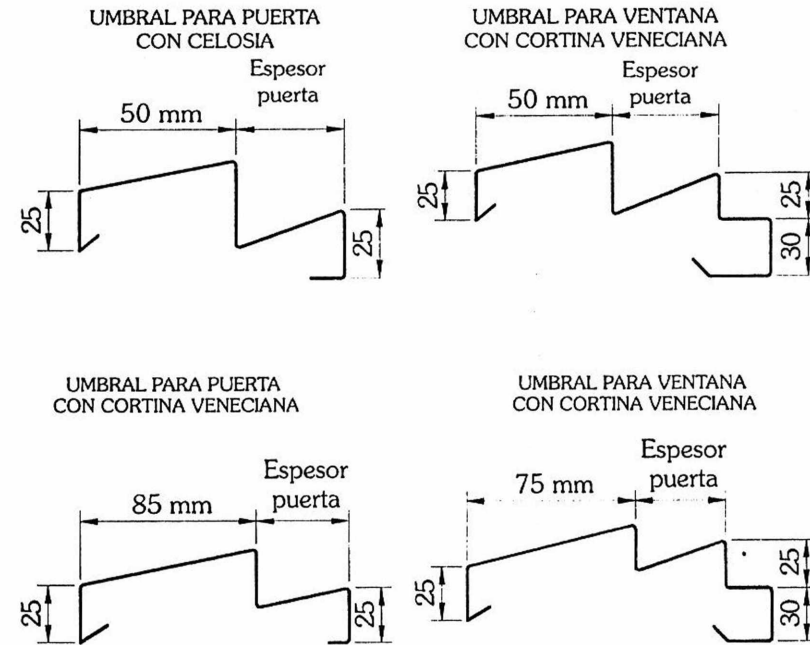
b. Perfiles de carpintería metálica, en chapa doblada.
